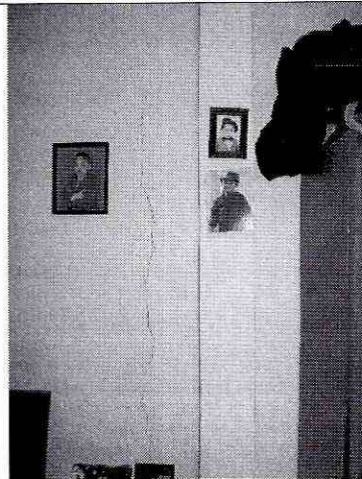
Estado actual de los muros interiores en el primer piso de la edificación. Se observan agrietamientos verticales debido a asentamientos.
